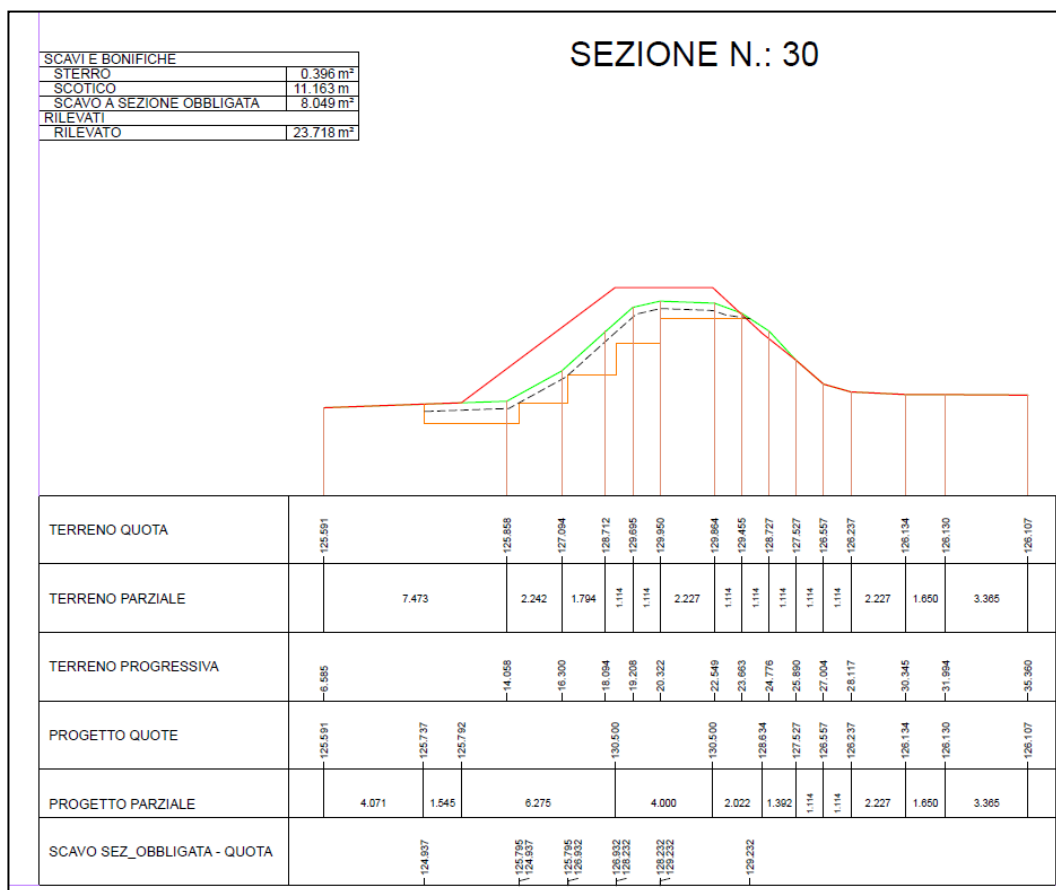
Intervento adeguamento argine area esondabile in dx Faella - sezione tipo.
